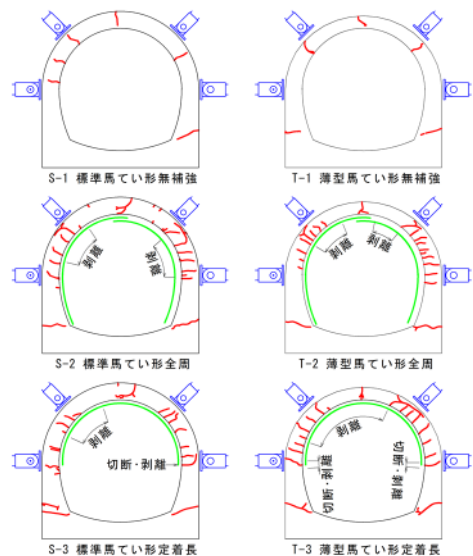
ひび割れおよび CFSS の剥離状況
